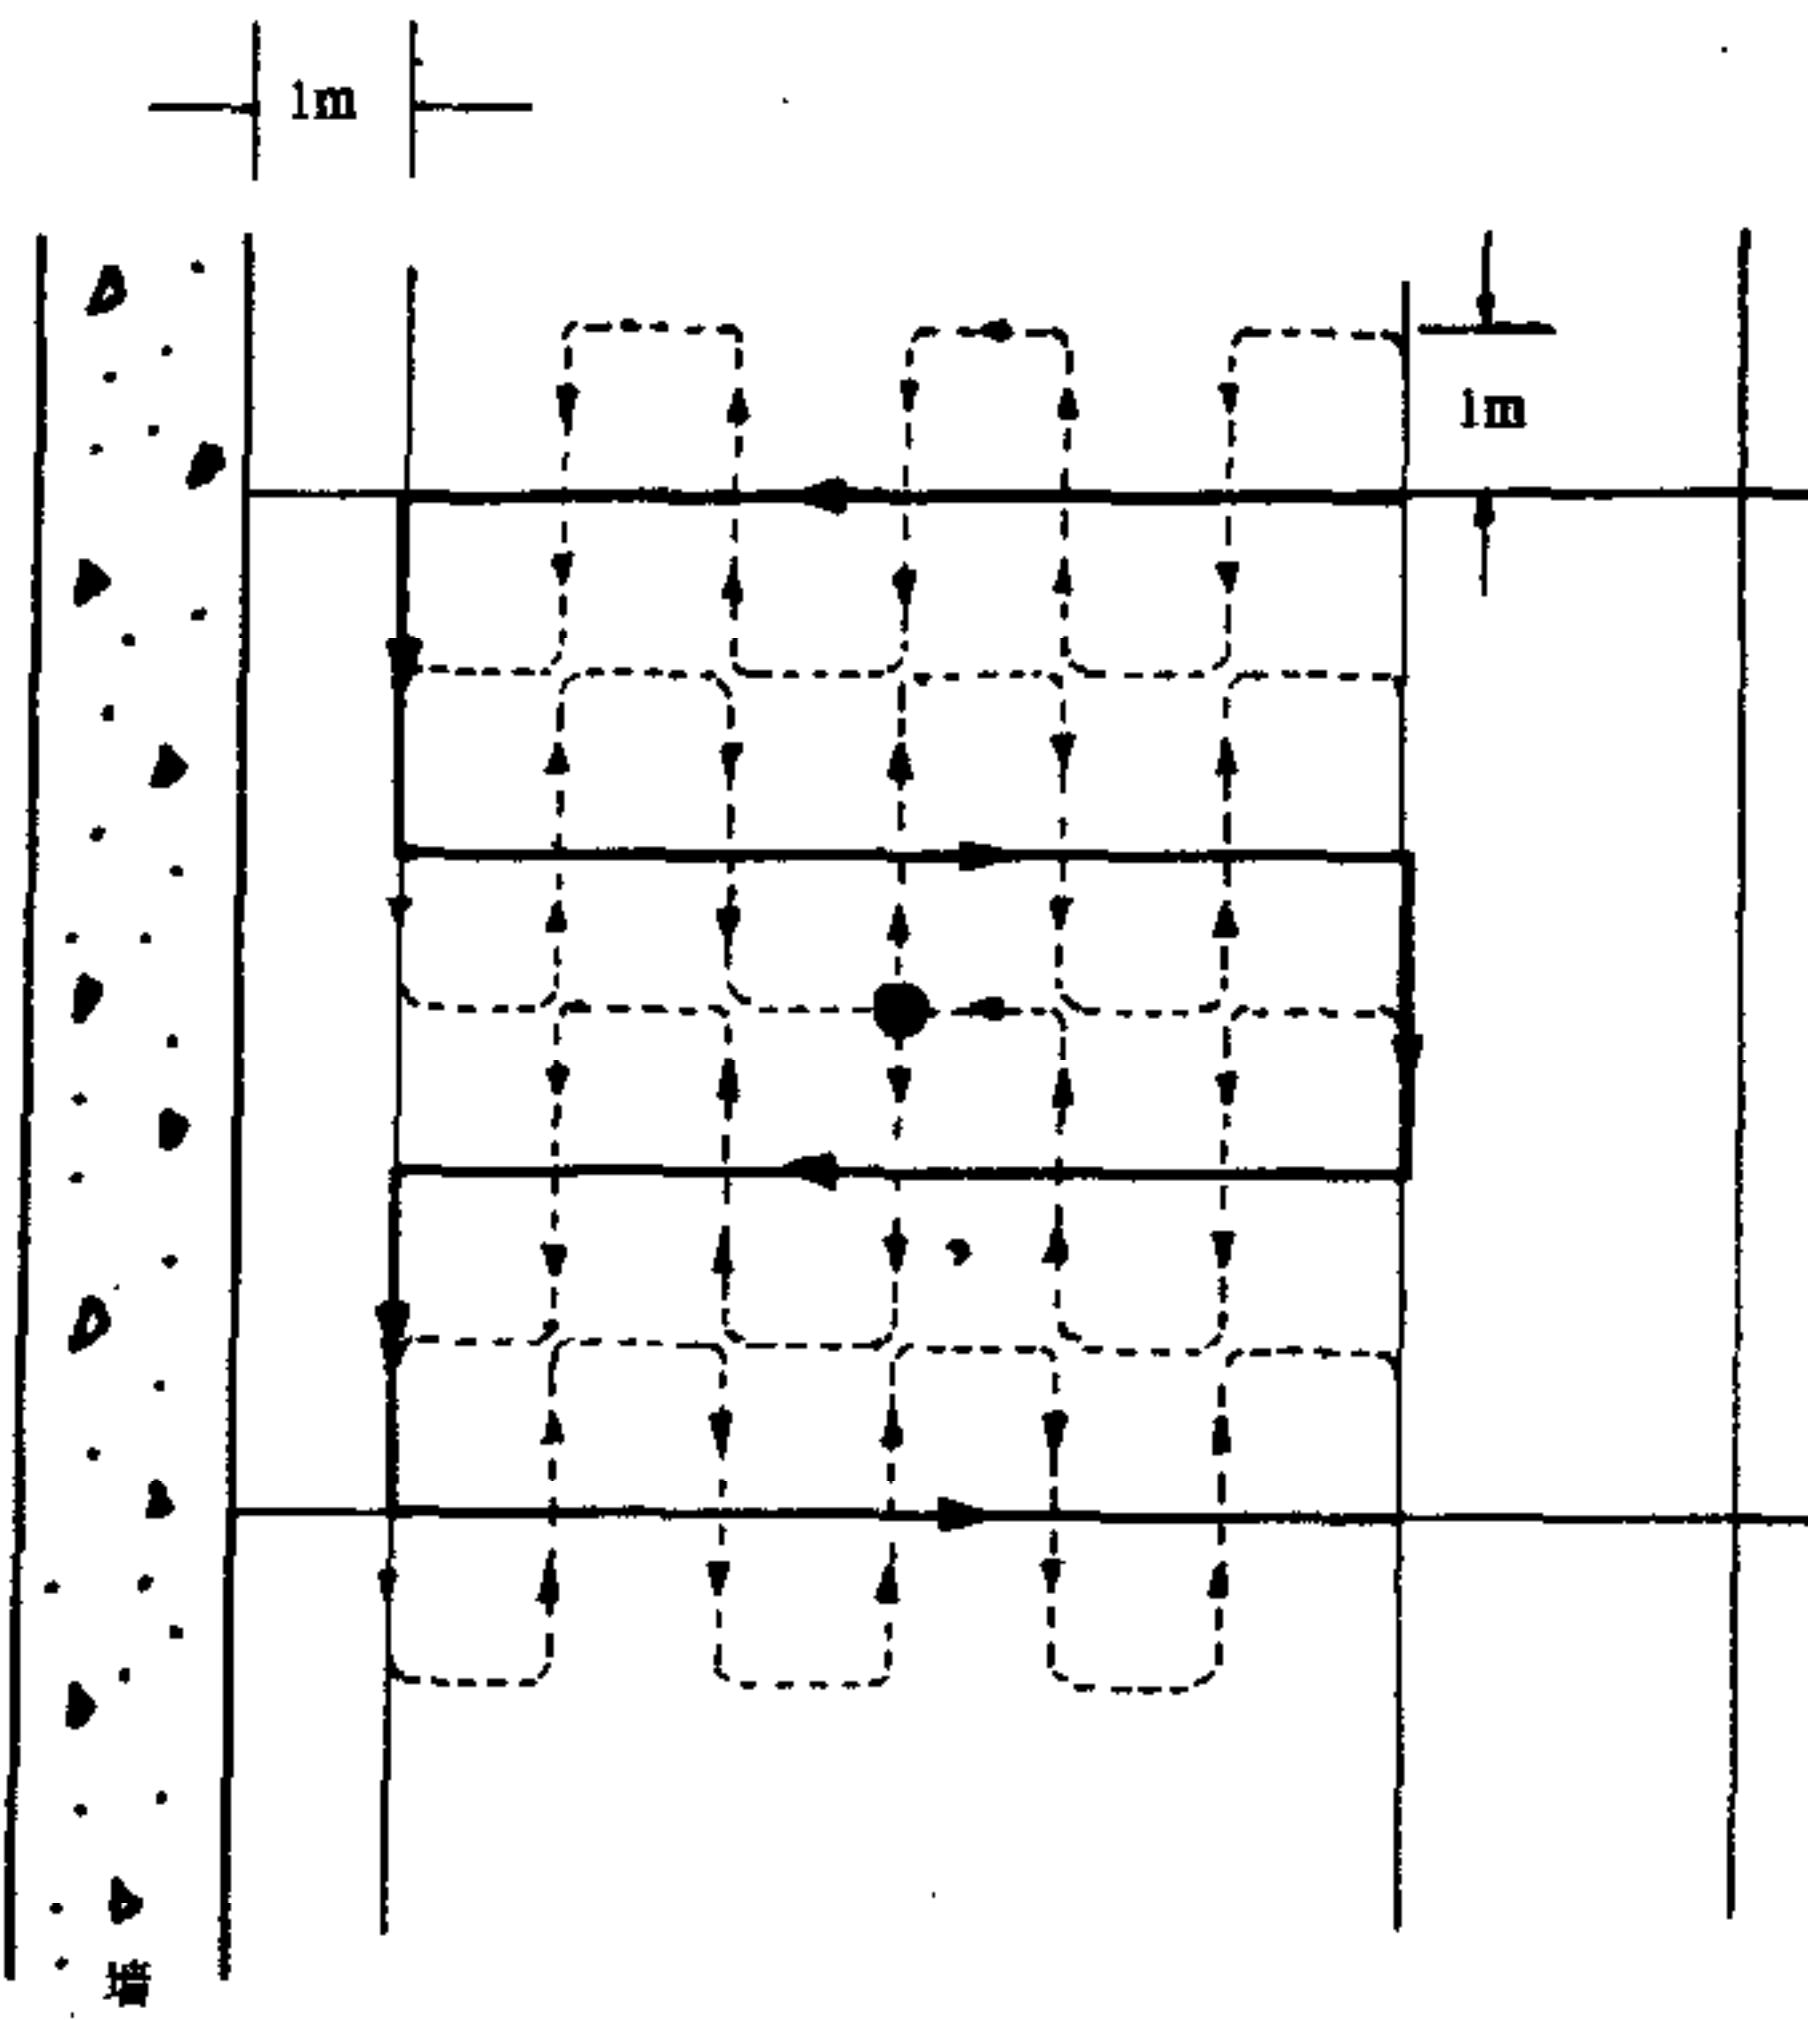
水平屏蔽体(平面图)扫描路线(B)示意图
